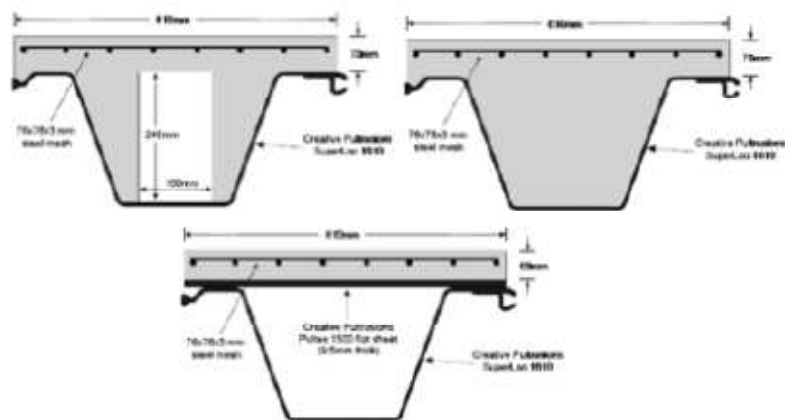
Distintas configuraciones de secciones de viga (Honickman, 2008)
